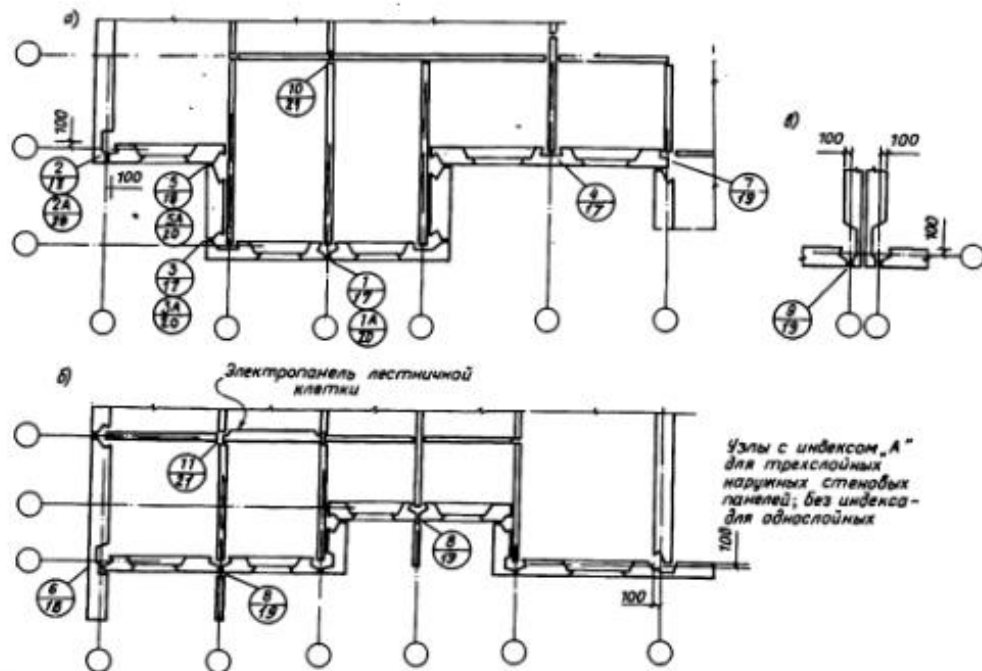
Крупнопанельные 5 - 9-этажные здания с малым шагом несущих поперечных стен, фрагменты монтажных планов установки стеновых панелей: а, б - варианты сопряжений панелей наружных и внутренних стен; в - температурно - деформационный шов здания
